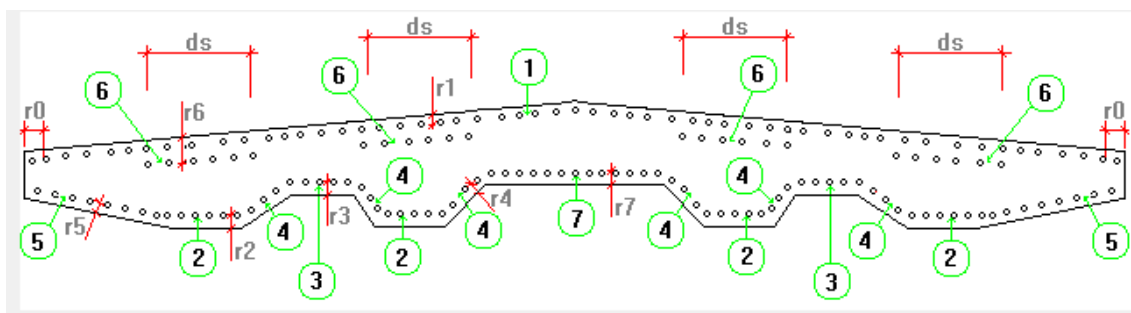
Armadura pasiva de la losa superior de hormigón. Definición de las posiciones de armado y de los recubrimientos para un cajón abierto.
